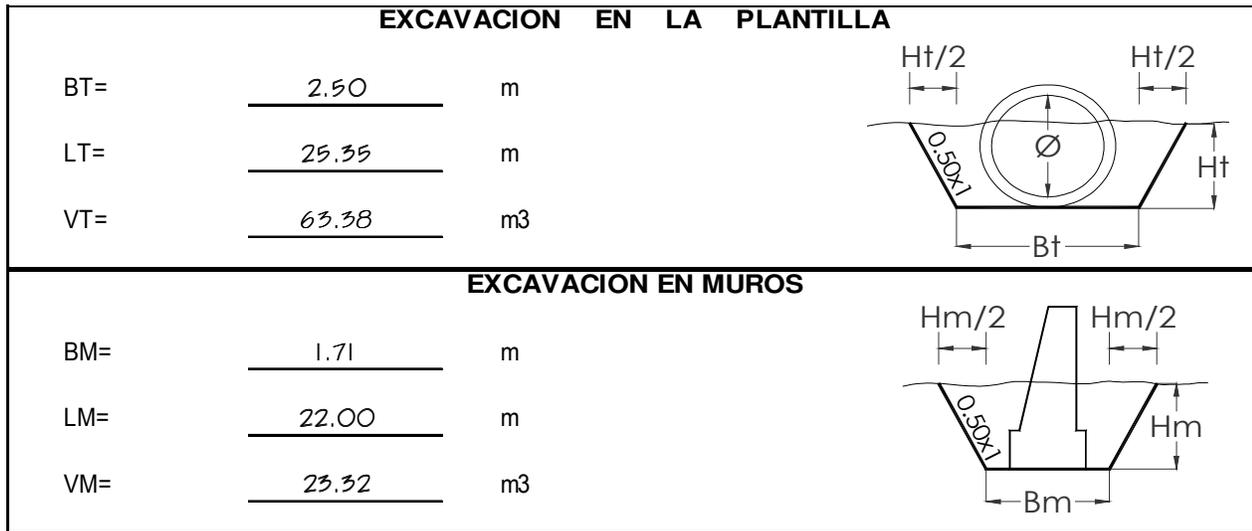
Ejemplo de datos de obra de drenaje a verificar en su construcción.
